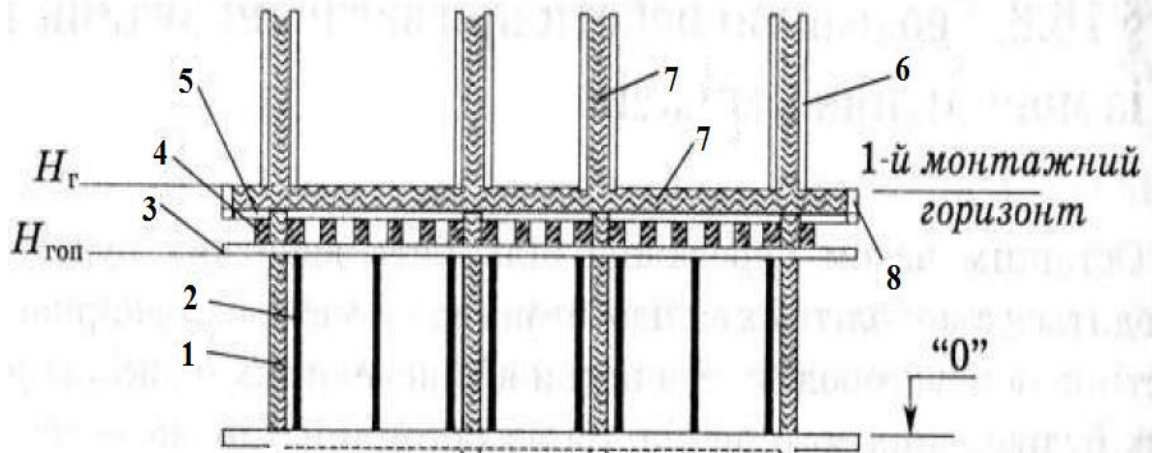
Схема зведення залізобетонного каркасу: 1 – залізобетонні колони 1-го поверху; 2 – інвентарна оснастка (підпорки); 3 – поперечні рейки (ребра жорсткості); 4 – повздовжні рейки (ребра жорсткості); 5 – плити перекриття монтажної оснастки; 6 – оснастка плити перекриття; 7 – короб оснастки колон; 8 – металевий каркас
